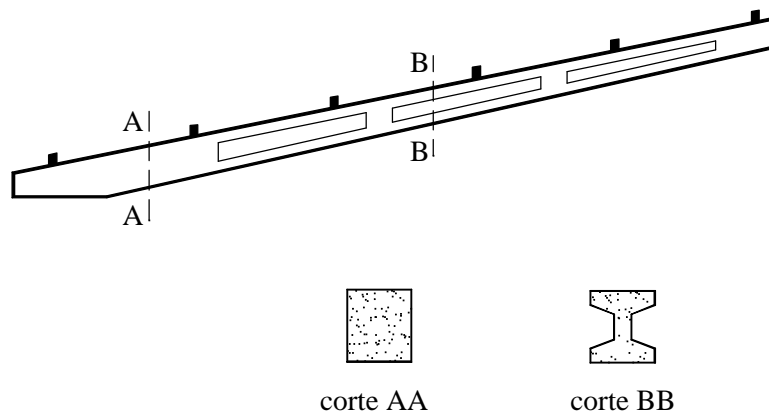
Forma longitudinal e seções transversais das vigas.
